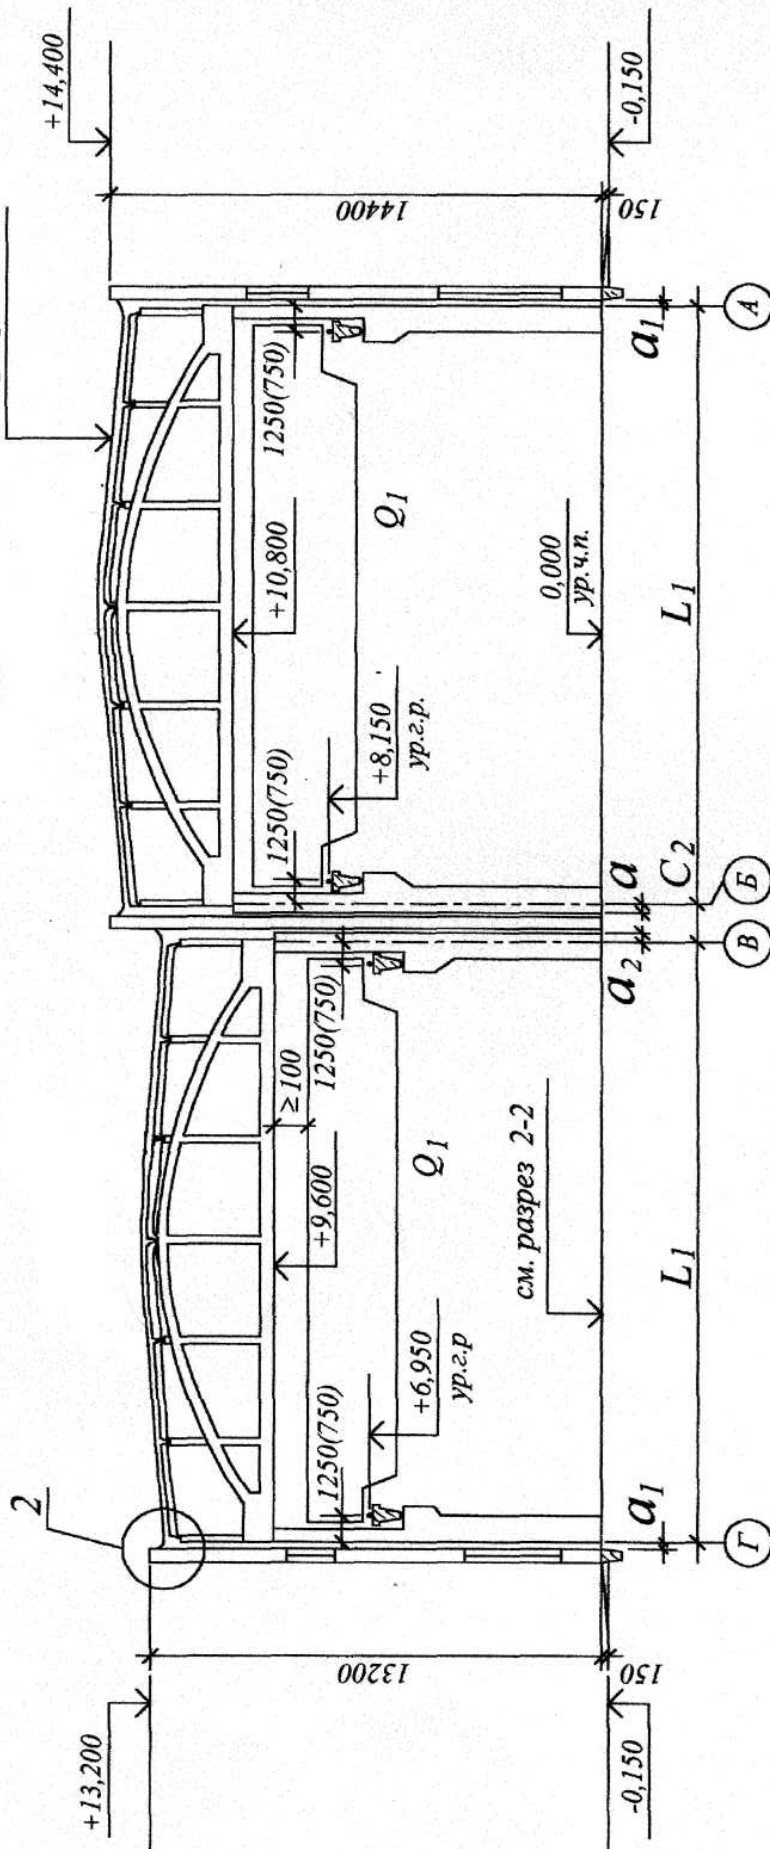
Пример выполнения поперечный разреза здания с перепадом высот смежных параллельных пролетов
